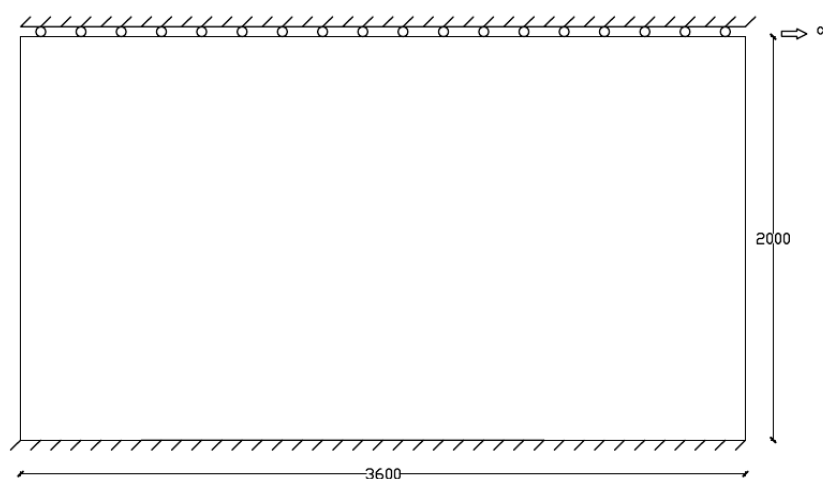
Parede de alvenaria em análise (dimensões em mm).
